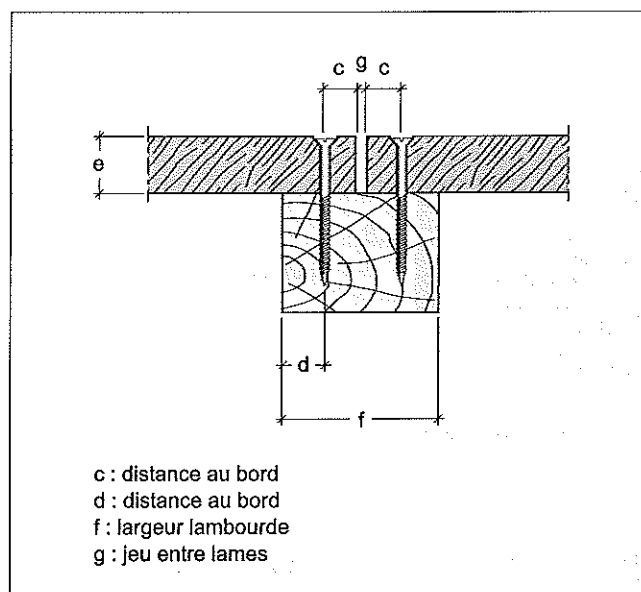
Disposition des fixations des lames de platelage sur lambourdes en bois – Débord longitudinal (source : DTU 51.4).
